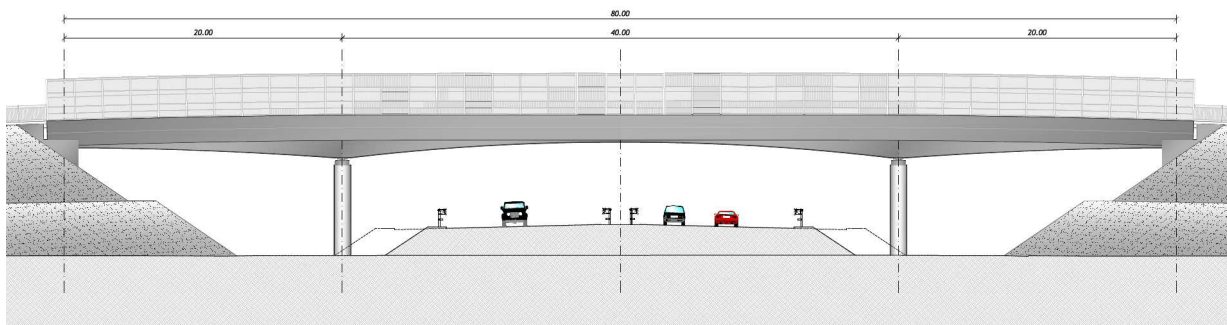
PROSPETTO CAVALCAVIA
